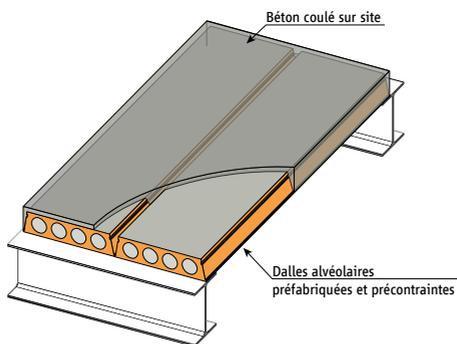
Plancher béton avec dalles préfabriquées alvéolaires
